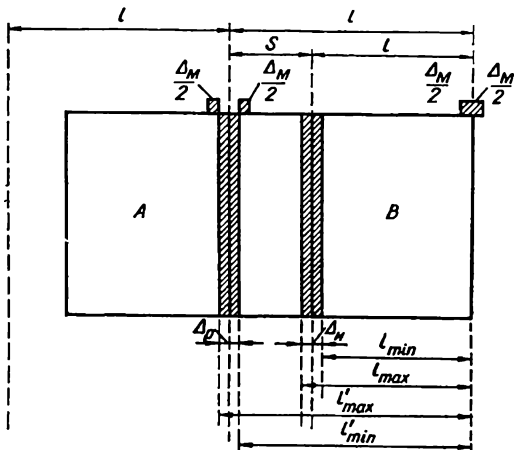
Расчет суммарного допуска конструкций.
